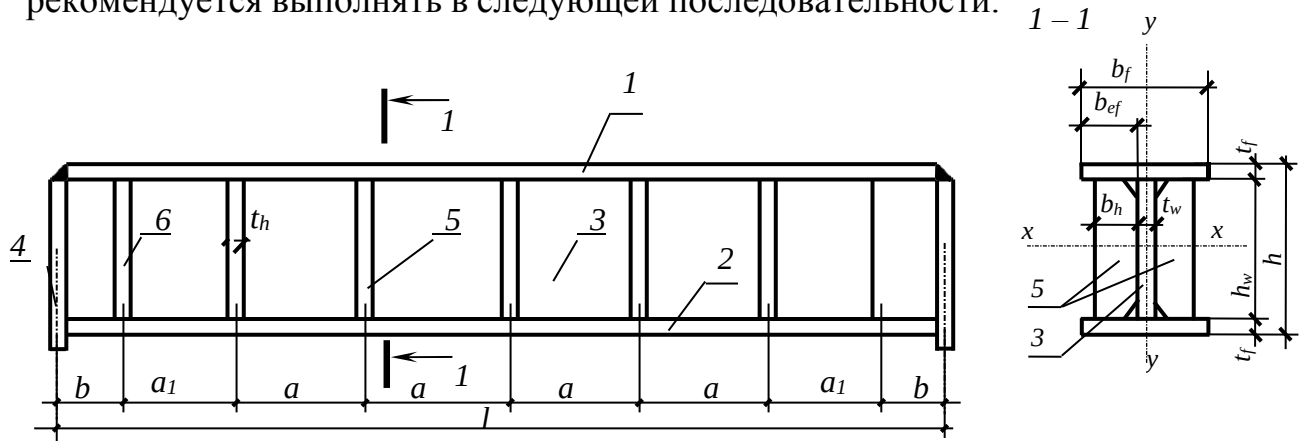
Схема балки с гибкой стенкой симметричного двутаврового сечения: 1– верхний пояс; 2 – нижний пояс; 3 – стенка; 4 – торцевое опорное ребро; 5 – основное поперечное ребро жесткости; 6 – дополнительное двустороннее поперечное ребро жесткости
